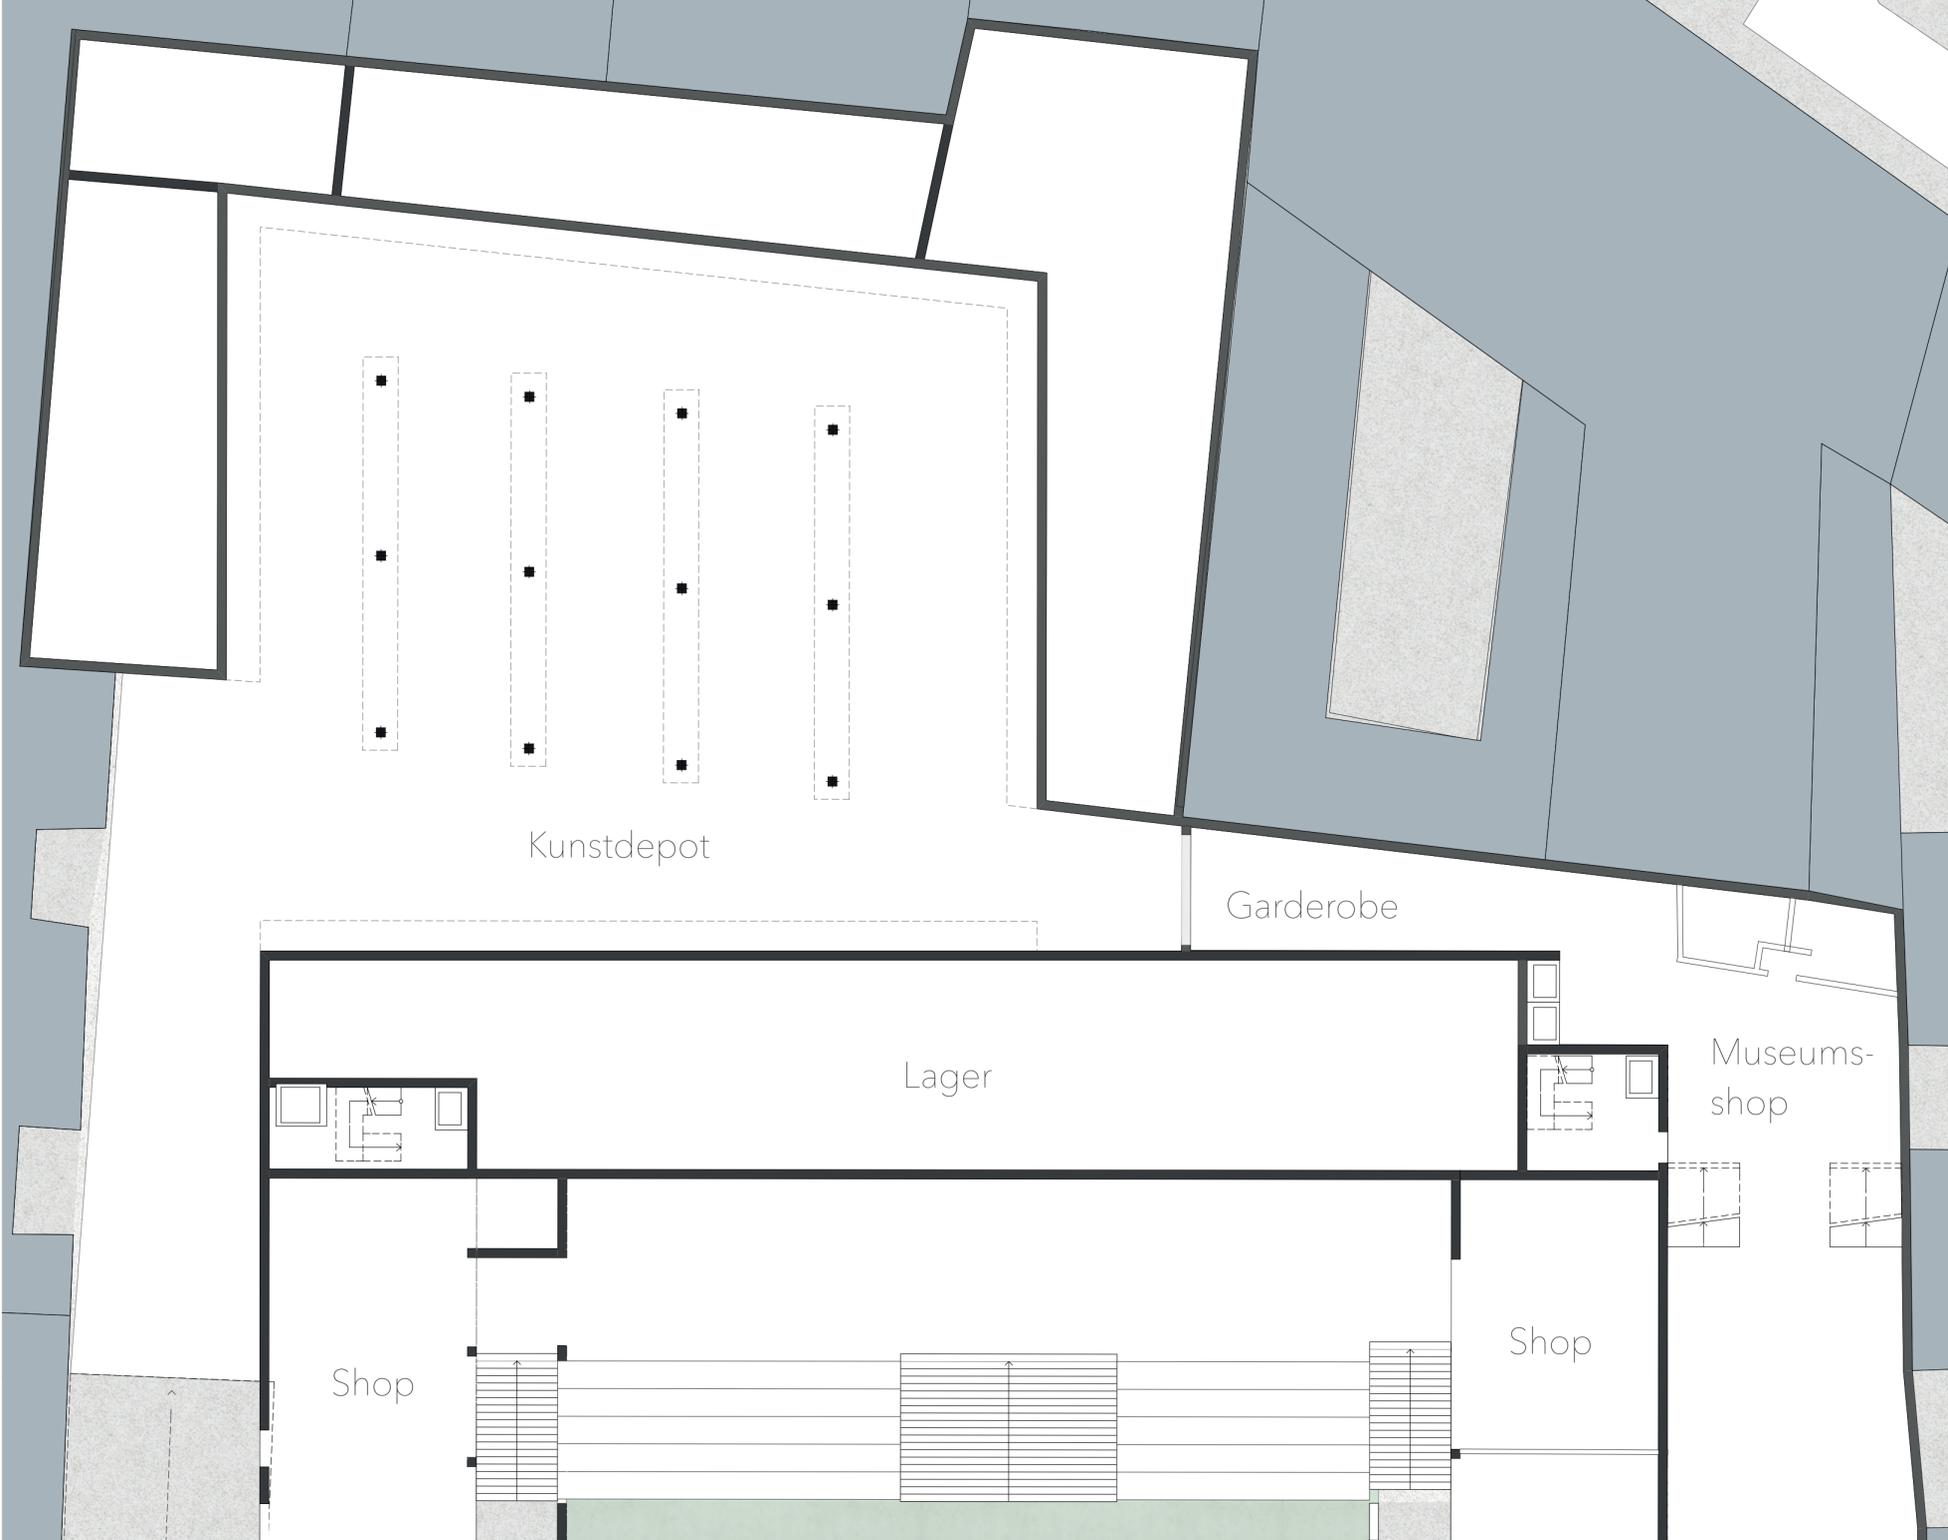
Untergeschoß 1 - 250 bietet Platz für Kunstdepot
